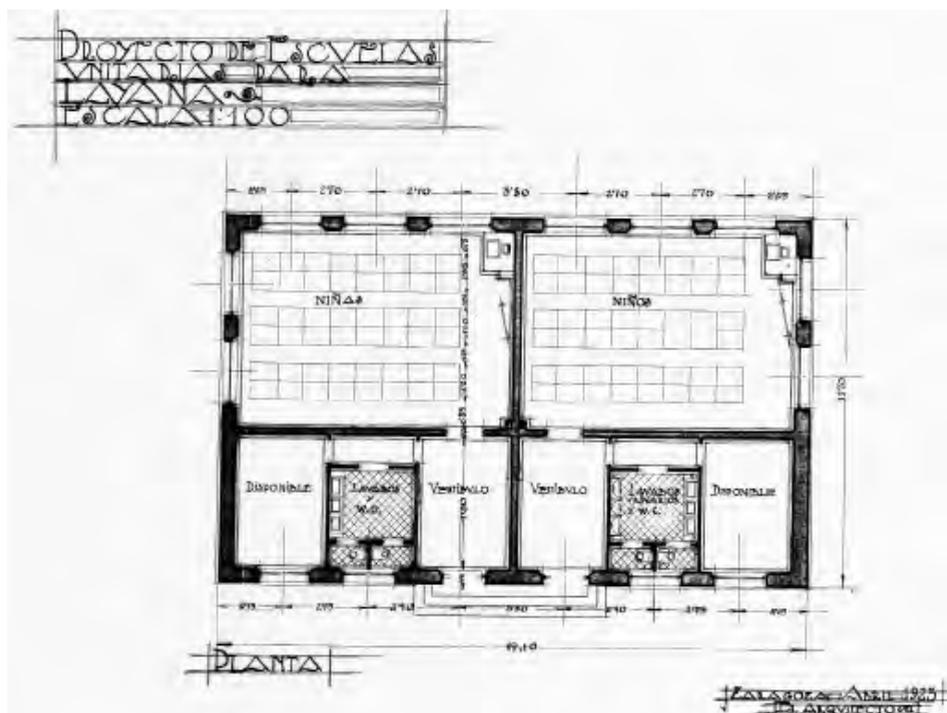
Planta de las escuelas unitarias para niños y niñas de Layana, firmada por el arquitecto Teodoro Ríos en abril de 1923 (Archivo de la Diputación Provincial de Zaragoza).
